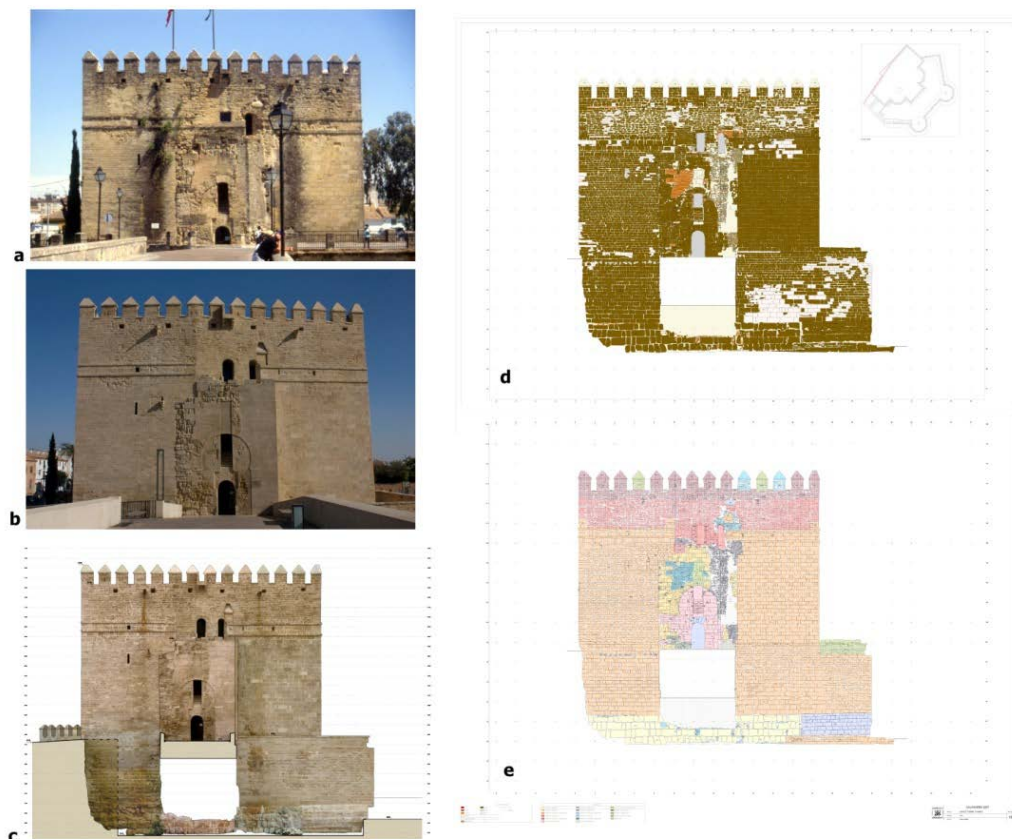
Fachada principal de acceso a la Calahorra. Frente Norte: a.- estado previo a la intervención; b y c.- fachada tras la restauración; d: alzado de la fachada (© Convenio GMU-UCO); e: lectura estratigráfica de la fachada (© Convenio GMU-UCO; CASTRO, 2009).
